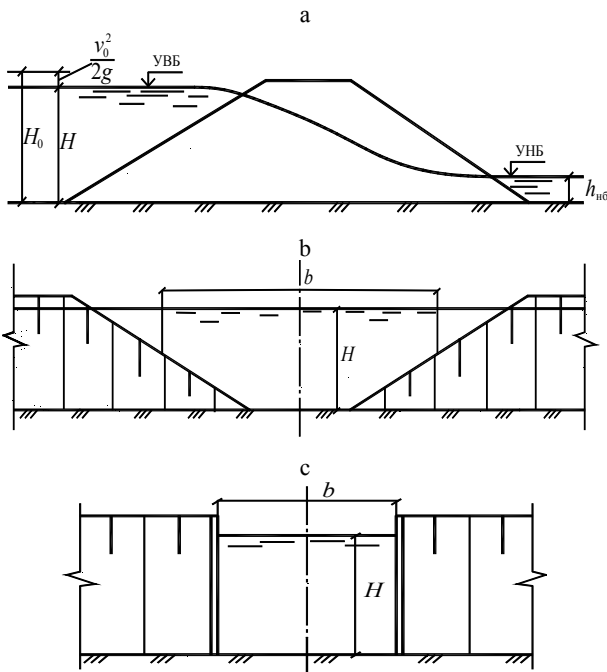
Расчетная схема к определению размеров водопропускного отверстия: а – поперечный разрез; б – трапециoidalное отверстие; с – прямоугольное отверстие; УВБ – уровень верхнего бьефа; УНБ – уровень нижнего бьефа
